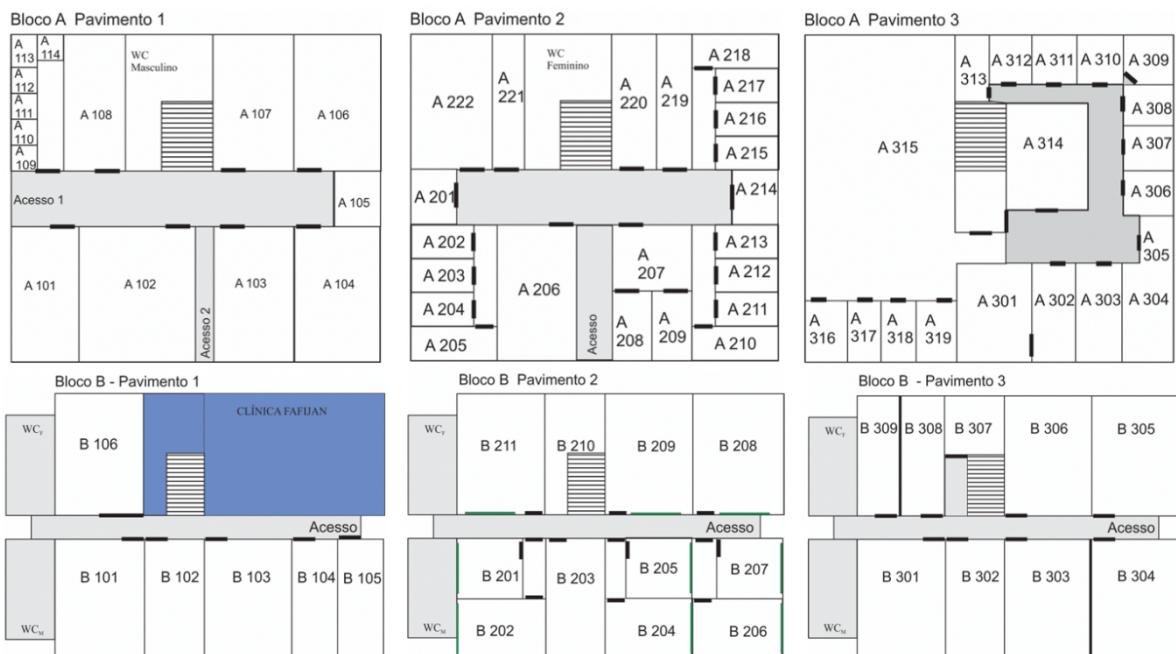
Estrutura física do Câmpus Avançado de Jandaia do Sul planejada em 2018.
